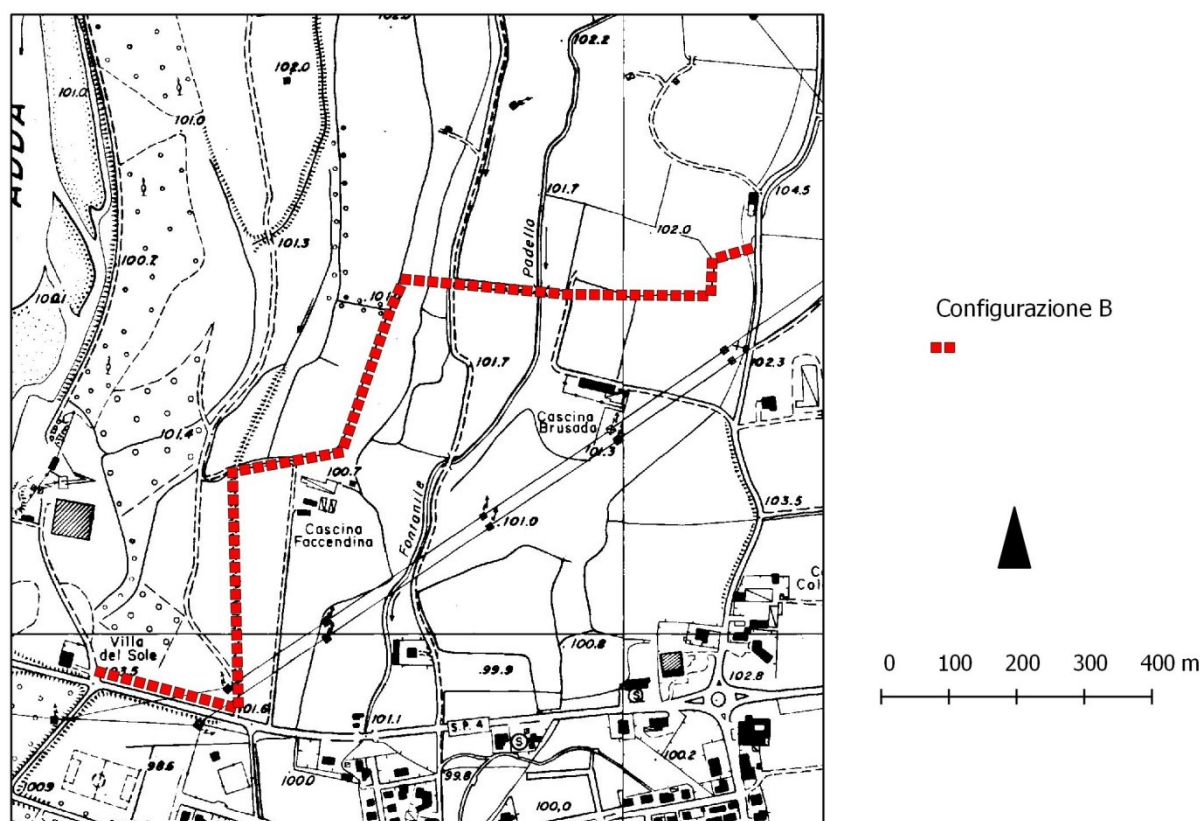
Planimetria del nuovo rilevato arginale di progetto - Configurazione "B"
